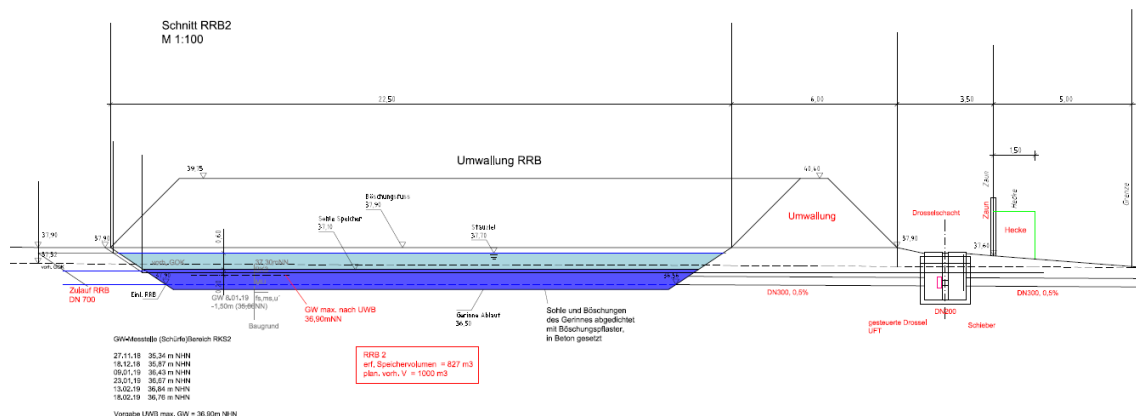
Auszug aus dem Entwässerungsplan, Ing.-Büro Addicks, Stand 20.08.2019
